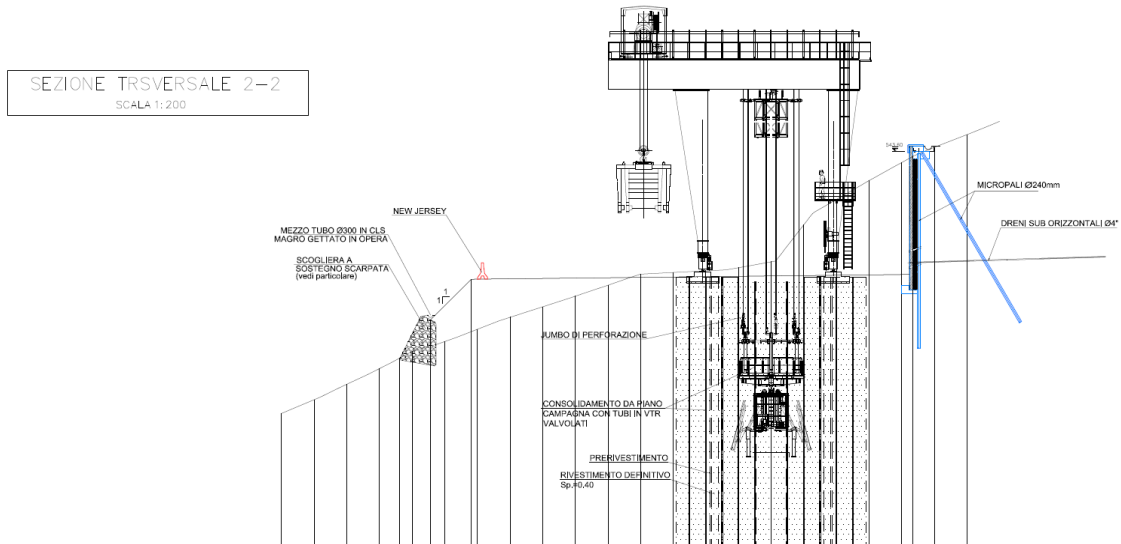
Cantiere pozzo: fase 2 – sezione in corrispondenza del pozzo e del carro ponte
